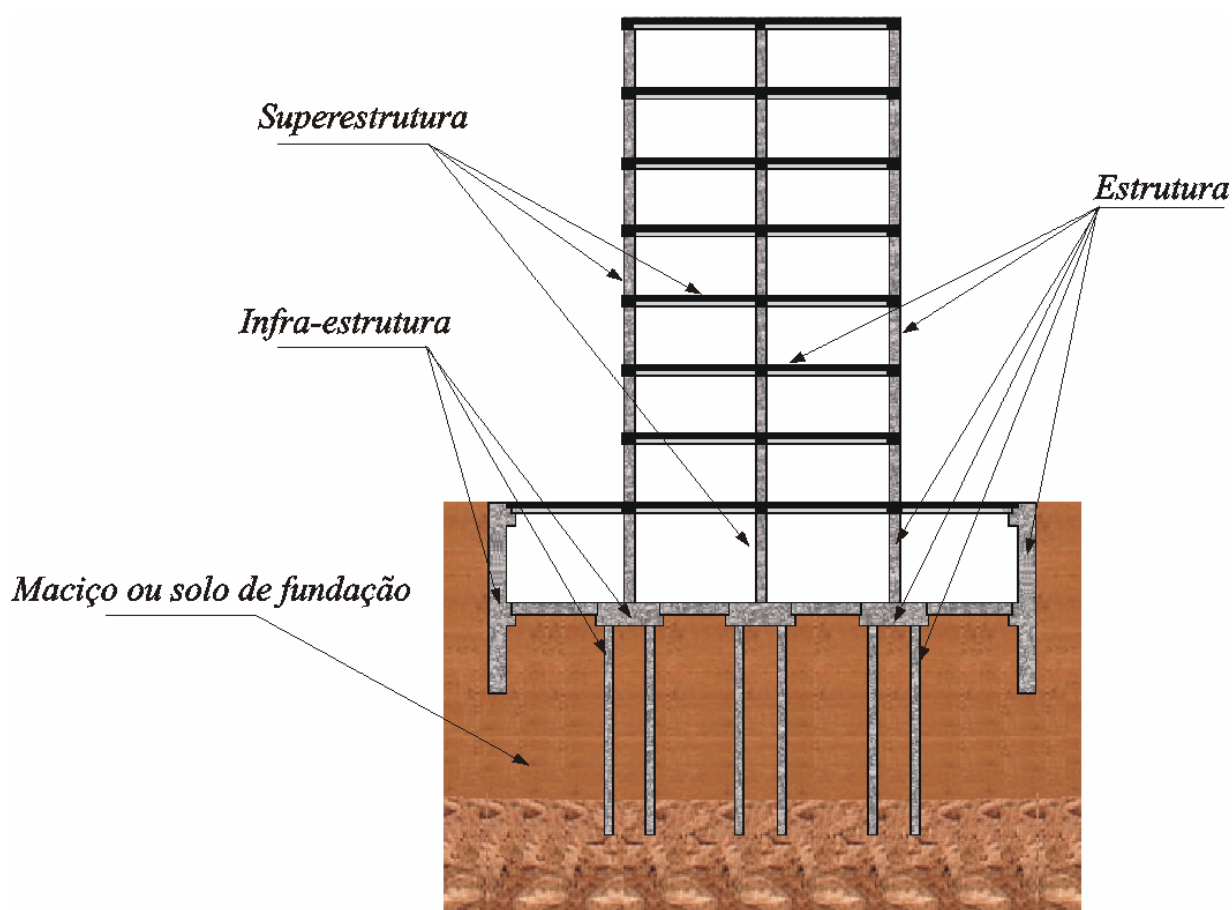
1 – Subdivisão estrutural de uma edificação.
